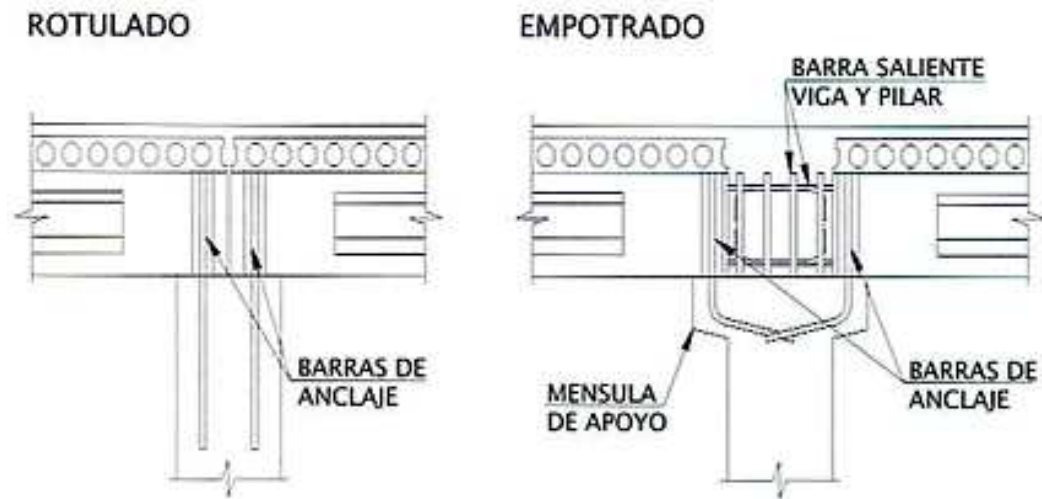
Sistemas de conexión losetas – vigas de techo
